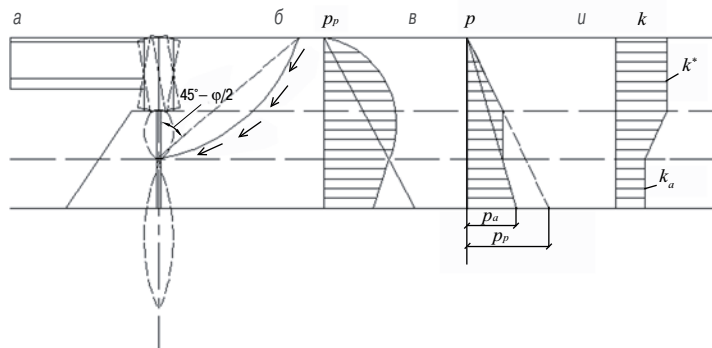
Схемы к определению коэффициентов давления грунта за интегральным устоем: а – деформации грунта насыпи и основания; б – эпюра пассивного давления; в – расчетная эпюра давления грунта; г – эпюра расчетных коэффициентов давления грунта
